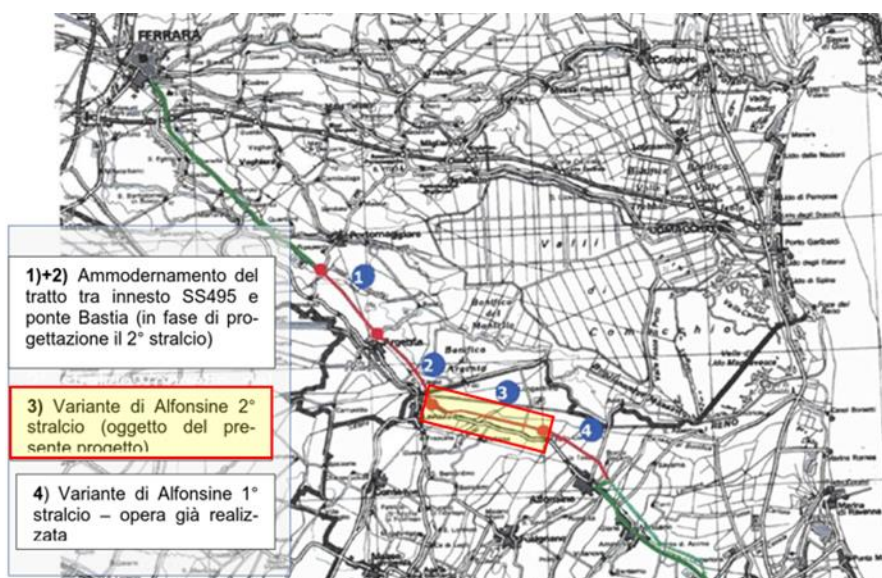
STRALCIO PLANIMETRICO DEL PROGETTO DI AMMODERNAMENTO DELLA S.S. 16 “ADRIATICA”, SUDDIVISO IN LOTTI FUNZIONALI.
